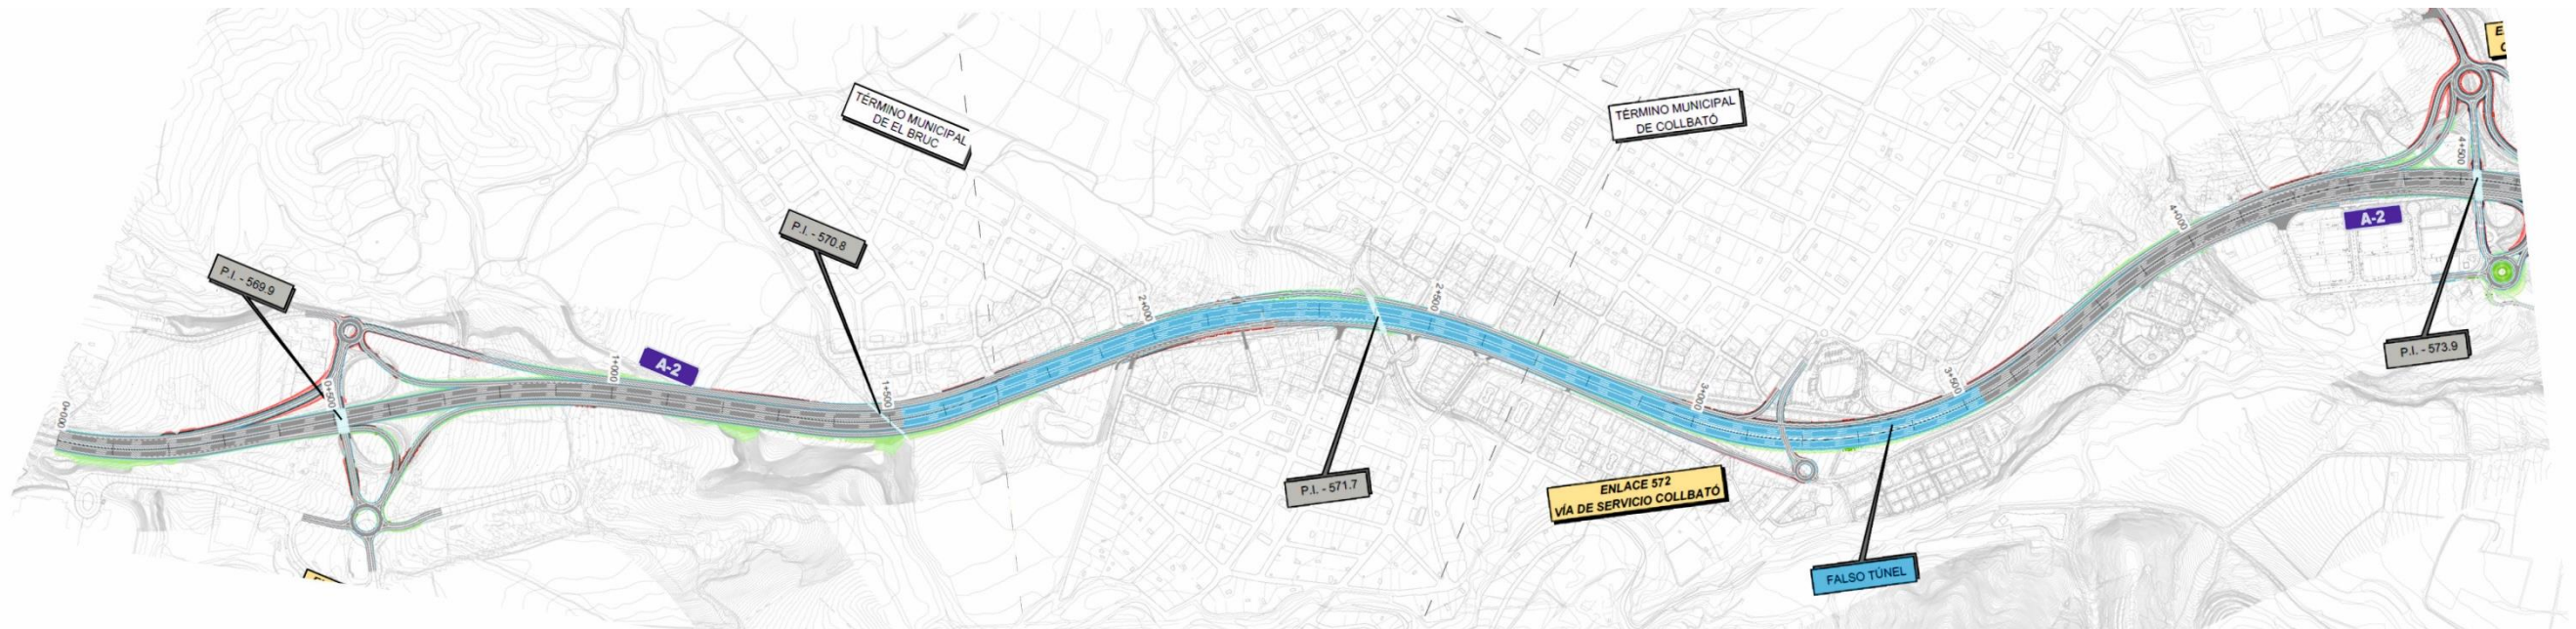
Planta topográfica del trazado del Falso Túnel de Collbató (elaboración propia).
